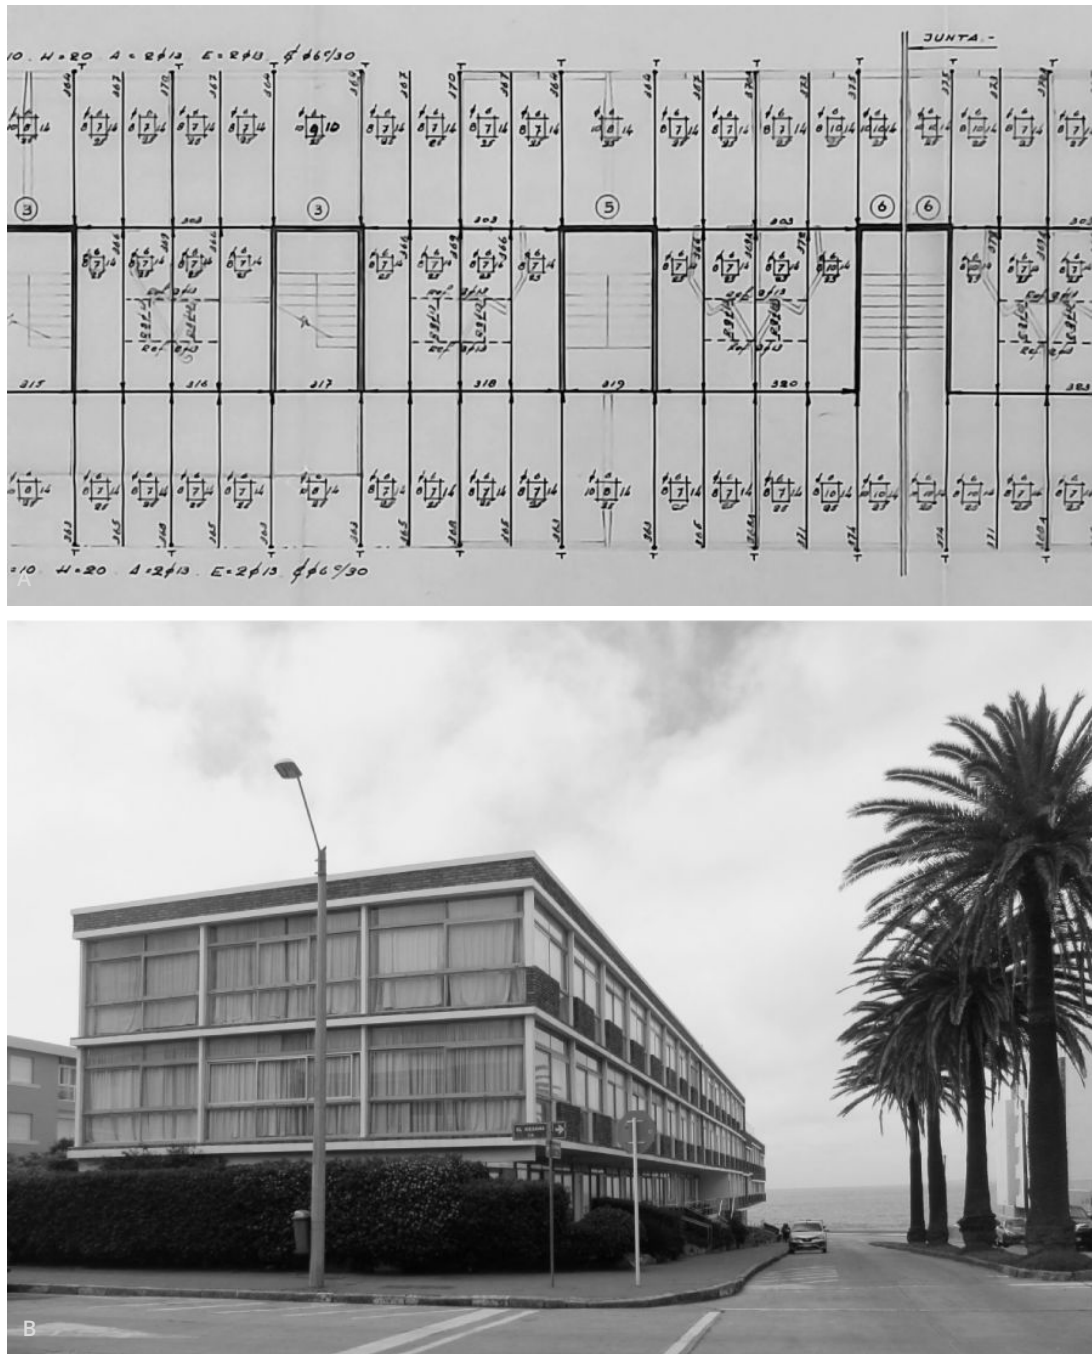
L'Hirondelle: A. Sector de planta tipo de estructura.
